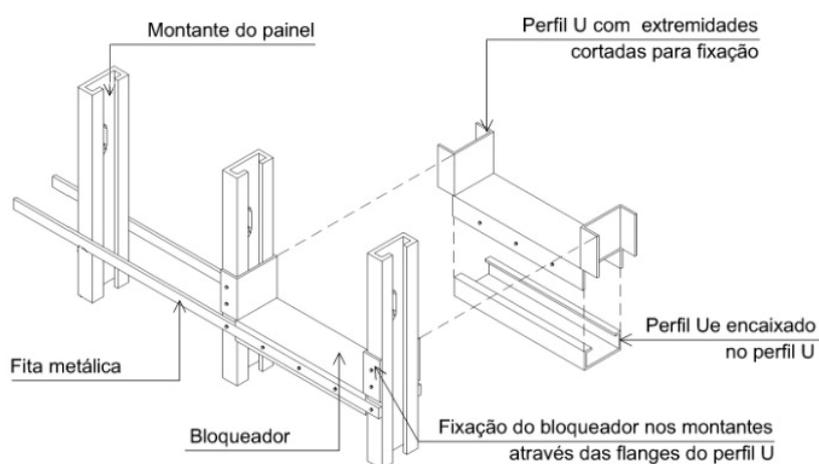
Esquema de travamento horizontal do painel por bloqueadores
